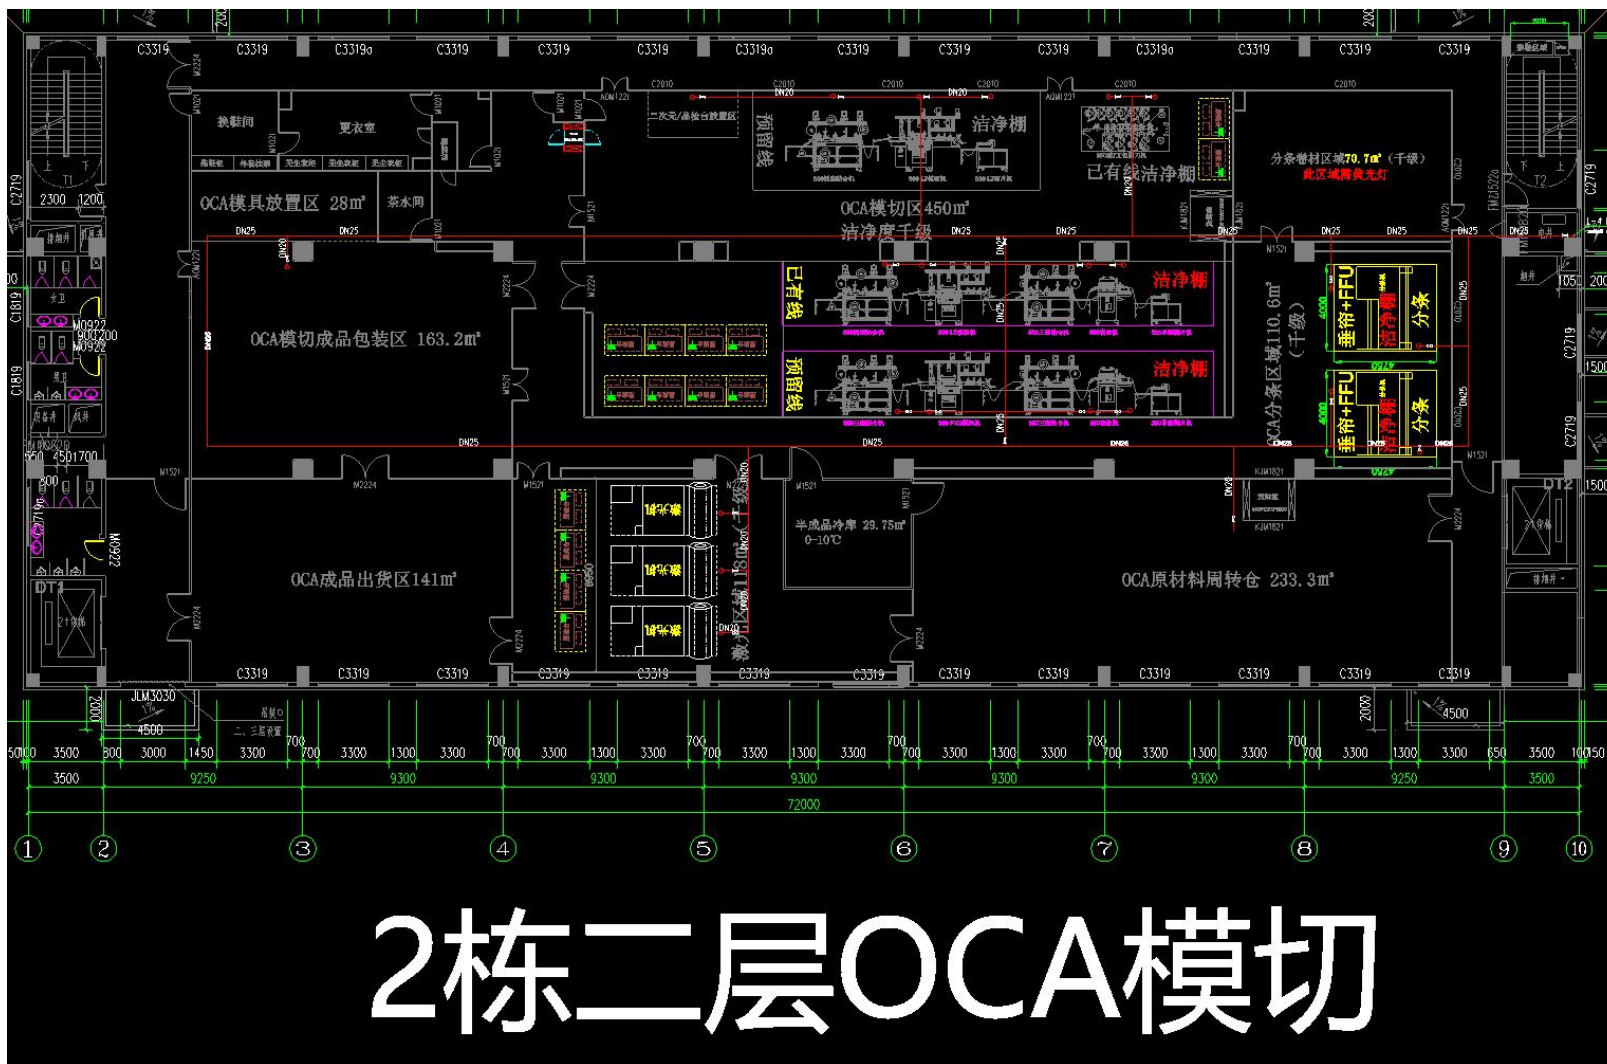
项目总平面布置图 (2 栋 2 层)
